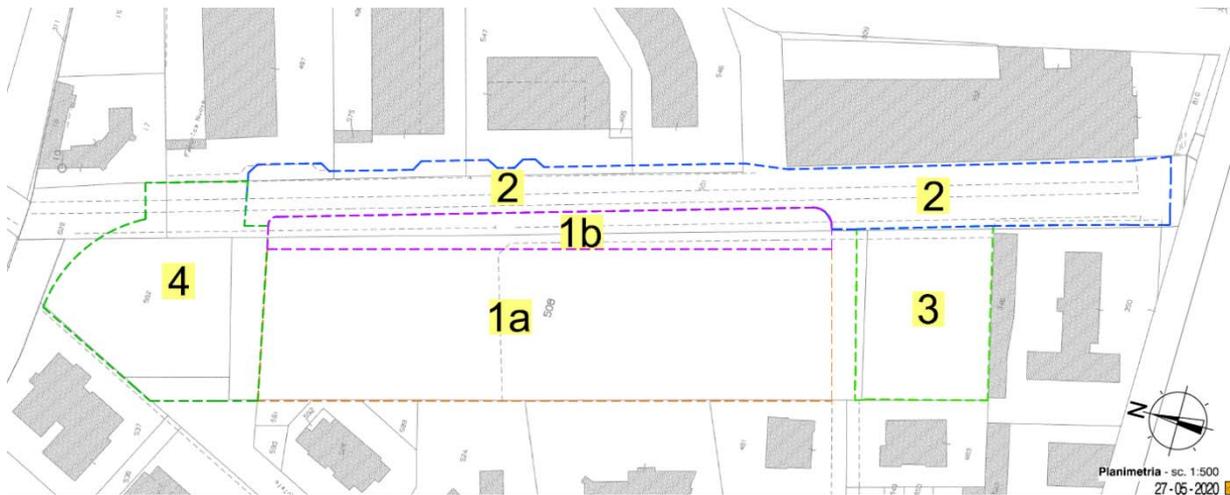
planimetria generale con individuazione degli ambiti generali di progetto
